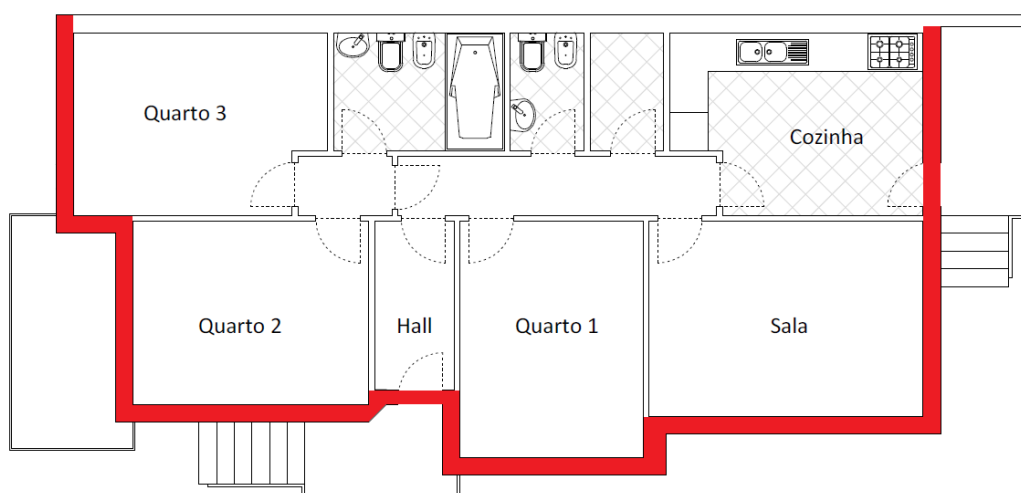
Ligação da fachada com desvão sanitário (ENU).
